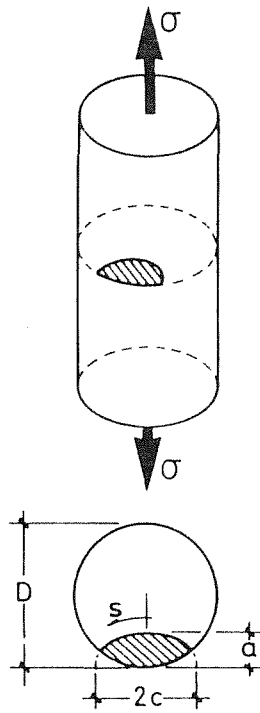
Barra de acero para armadura con fisura de superficie
